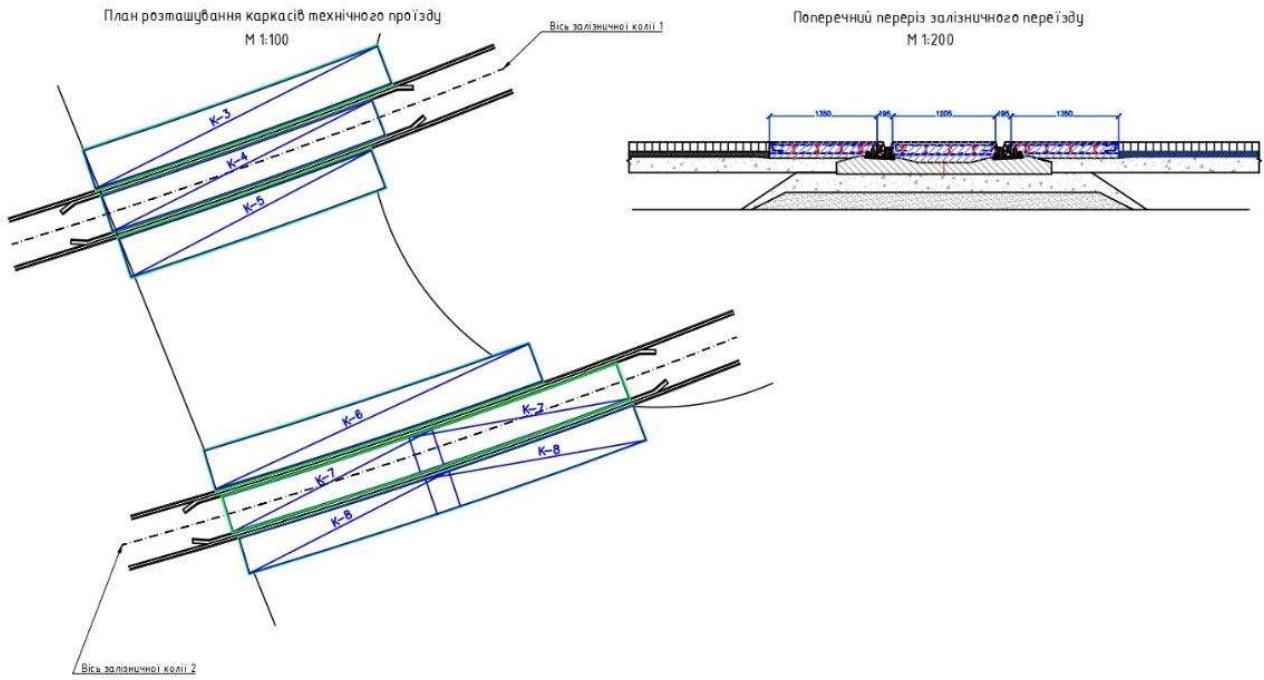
План та поперечний переріз монолітної залізобетонної плити
